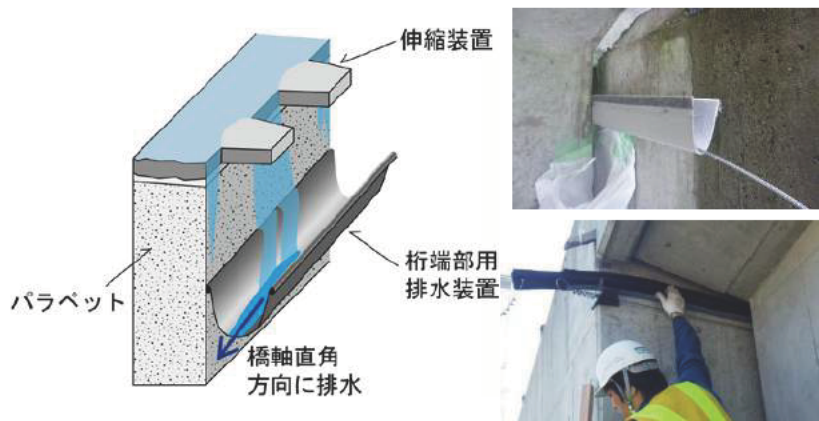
コンクリート橋桁端部の狭い遊間に設置可能な排水装置の提案、試験施工（右上：ポリエチレン製、右下：ゴム製）
